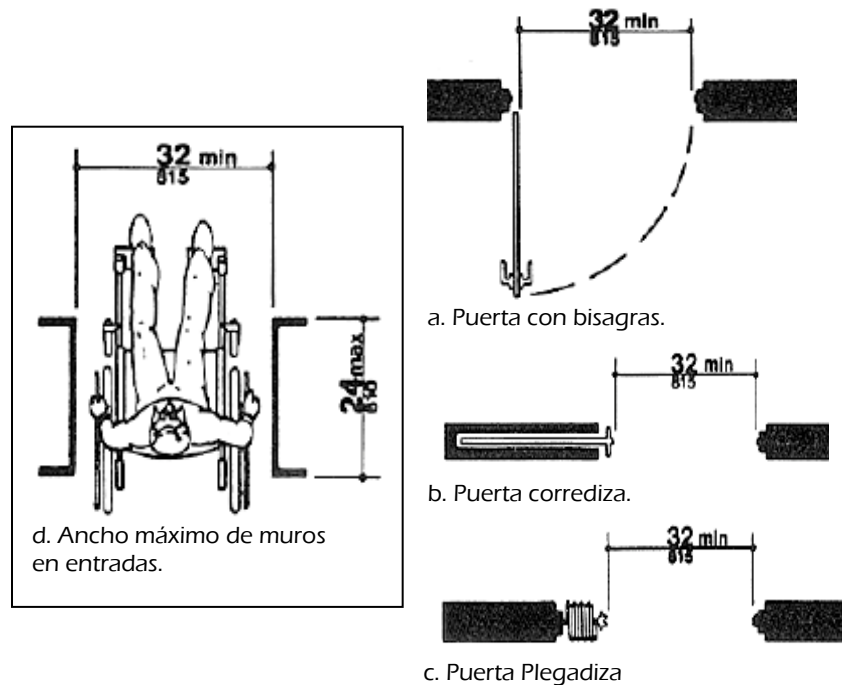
Dimensiones para claros de puertas y anchos de muro. Fuente Op.Cit. pp.37.
